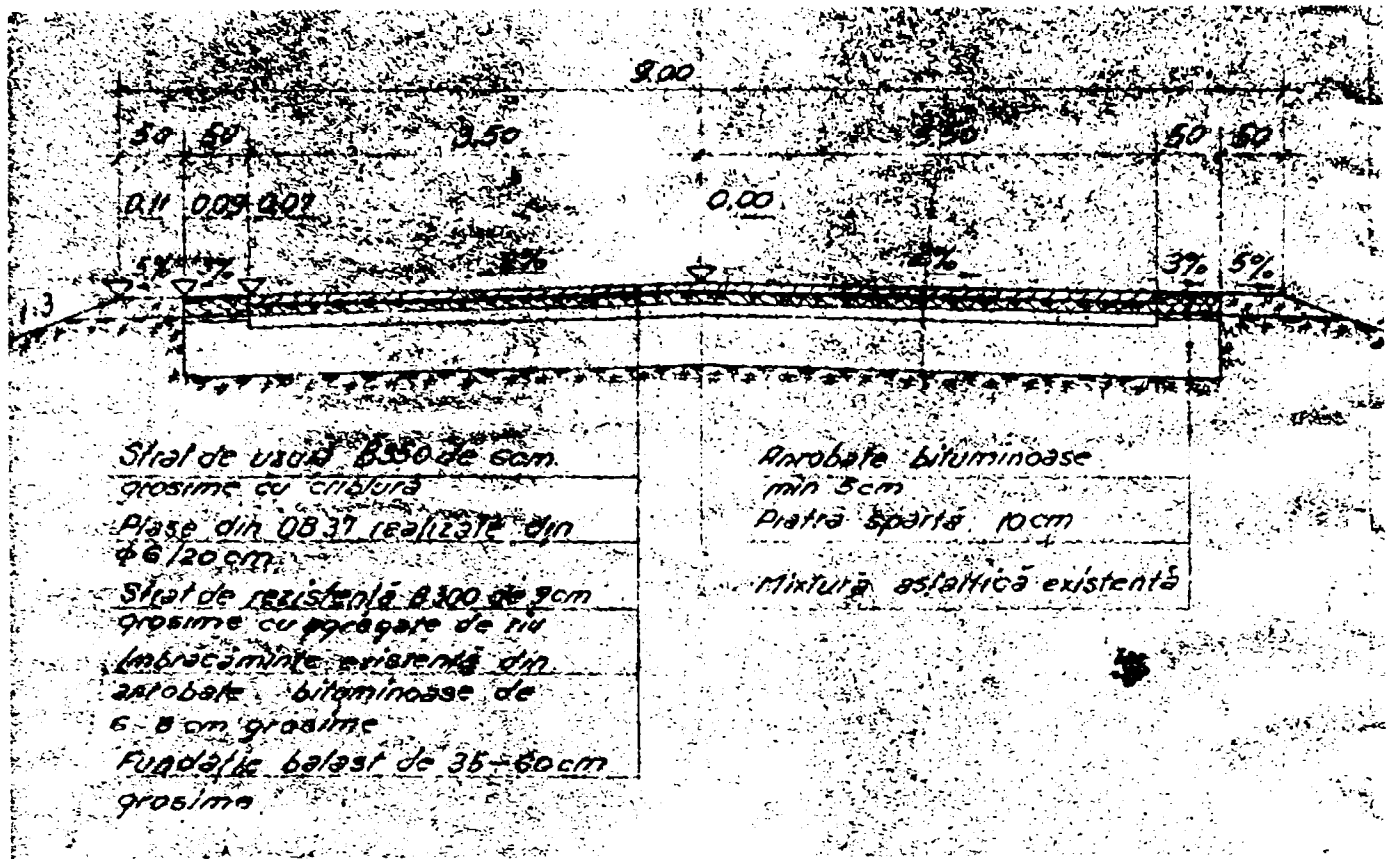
Profil transversal Tip II cu îmbrăcăminte din beton armat cu plase de sârmă.
